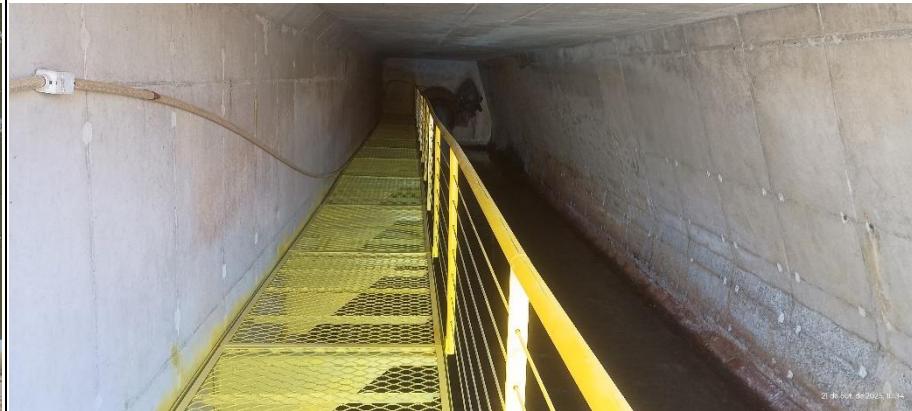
Passarela de acesso para inspeções abaixo da barragem.
